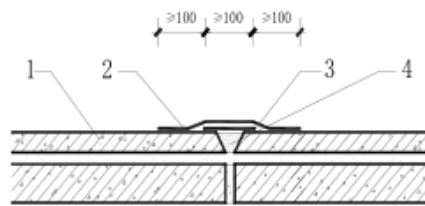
刚性混凝土防水层宽裂缝渗漏维修
